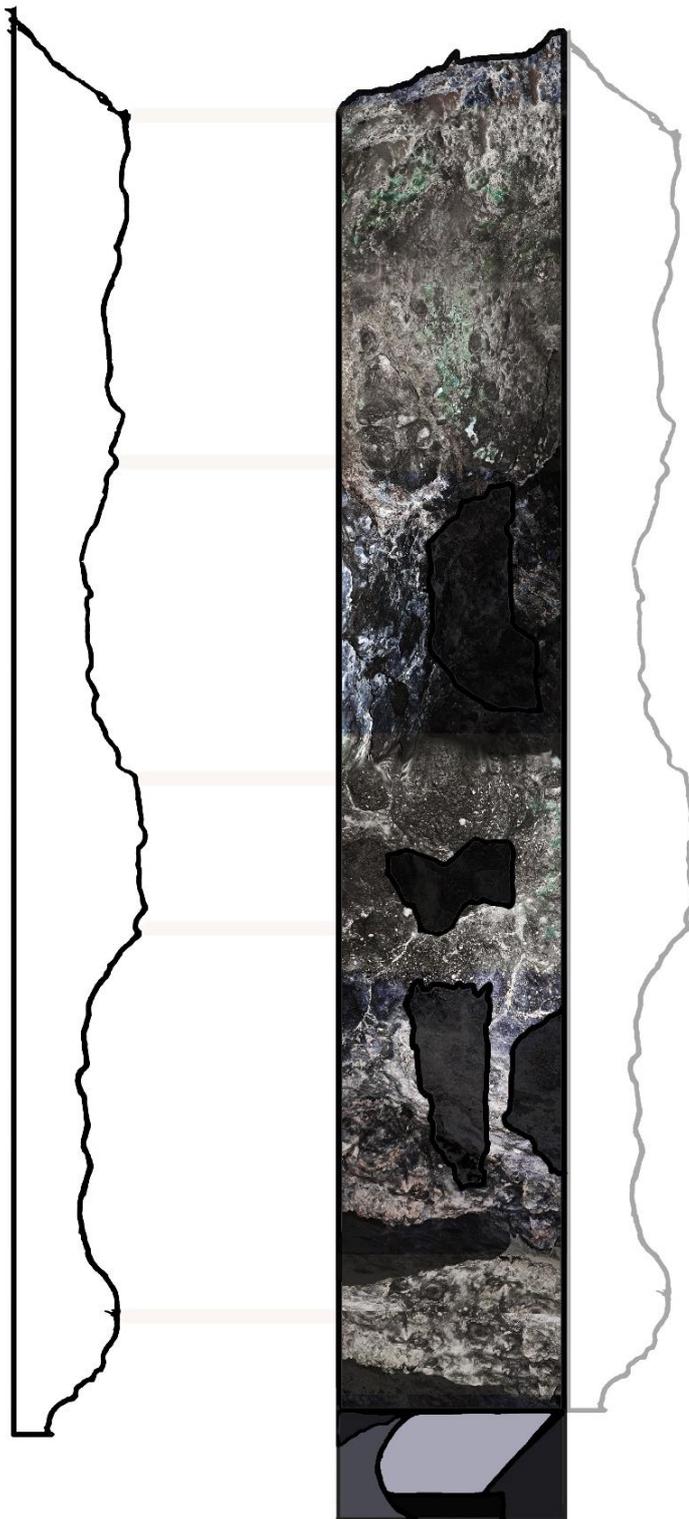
Vista en planta y en alzado de la pared de la necrópolis donde se expondrán las hueseras.
